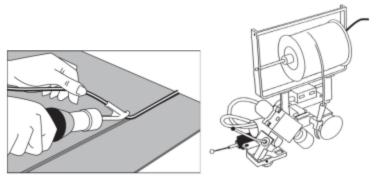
Réalisation du cordon pour la soudure à chaud des joints
